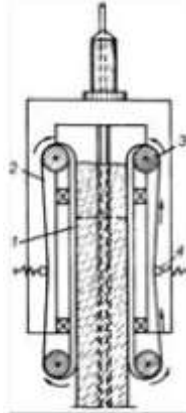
Приклад ковзної опалубної системи із рухливими формоутворювальними елементами [4]:
